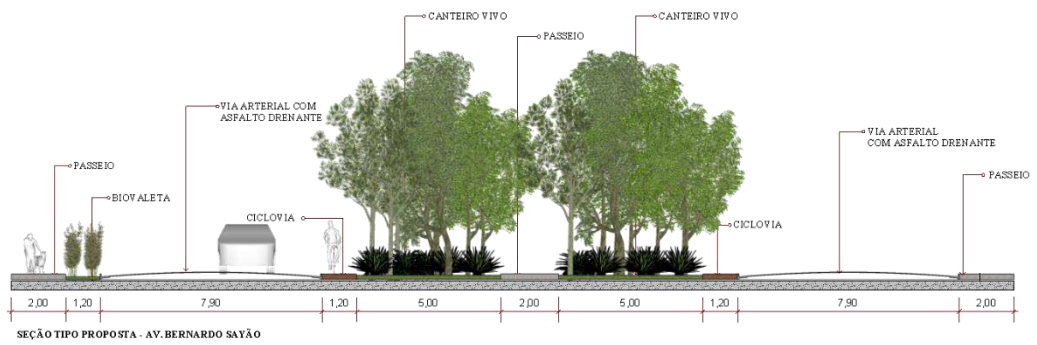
B: PROPOSTA APLICADA A VIA
